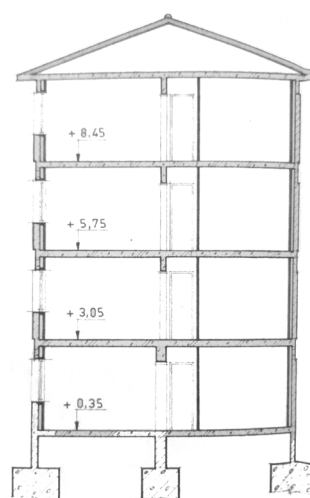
Plano de la sección transversal A-A' de la edificación situada en la Rúa Vilagarcía-Arousa, nº 6 (fotografía de autoría propia).
